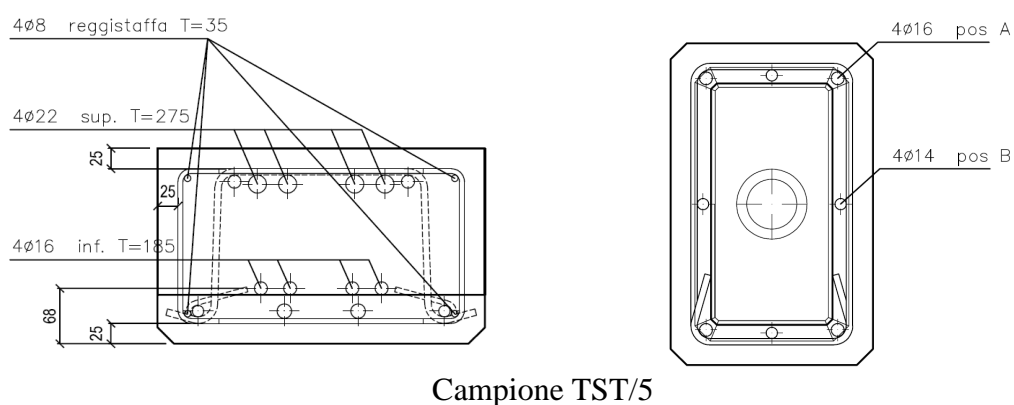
Sezioni correnti della trave e del pilastro – campione TST/5 con pilastro in asse forte
